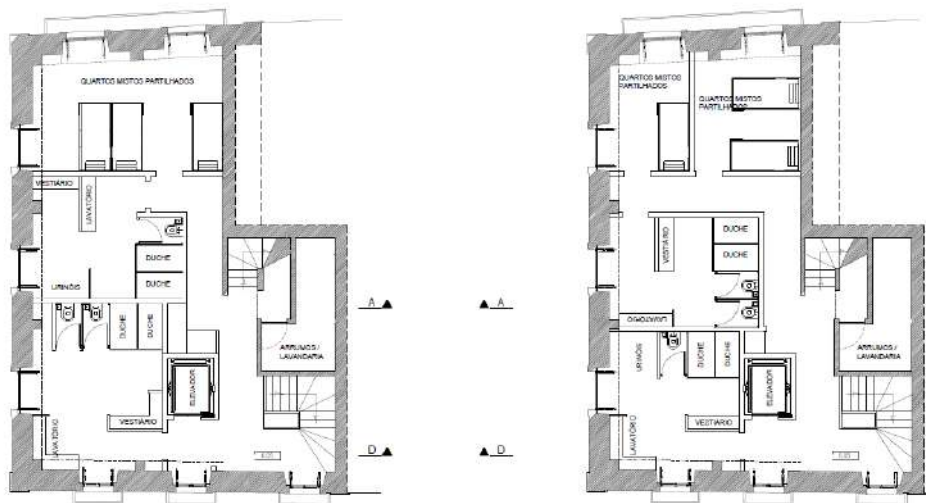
Esboços de estudo, em autocad, de uma proposta preliminar (2º Piso)
